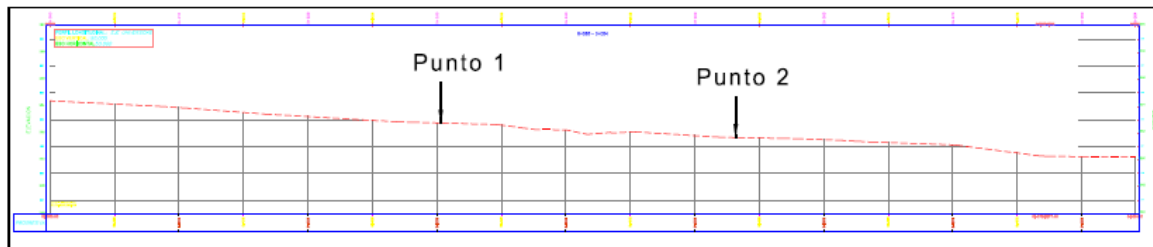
Vista de perfil de la ubicación de las perforaciones para el estudio geotécnico.
